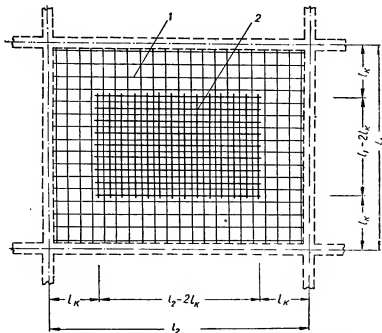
План нижней арматуры плиты, опертой по контуру:
